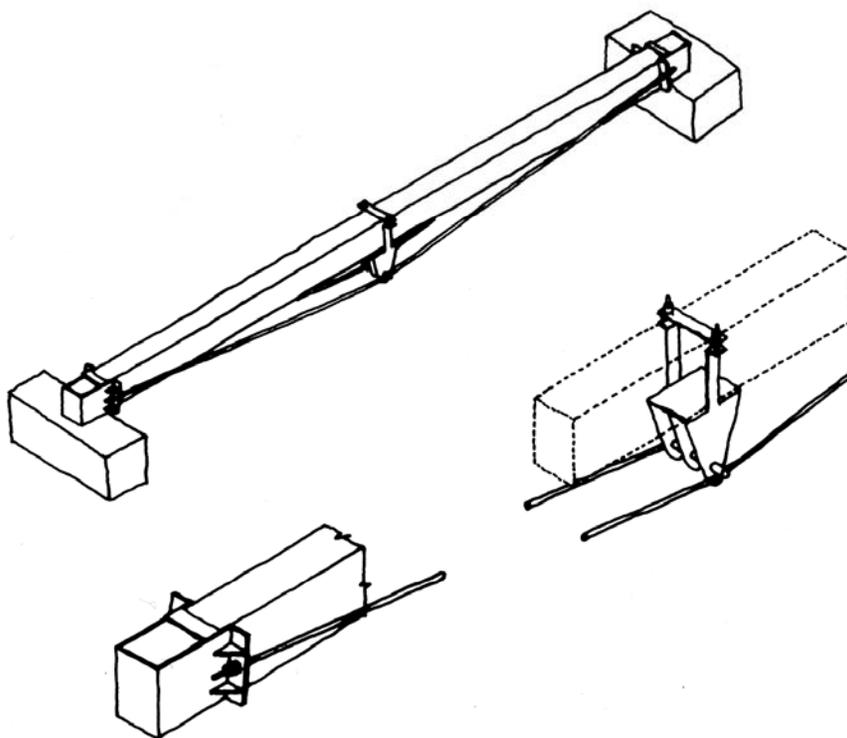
Refuerzo de una viga mediante la disposición de un tirante inferior.
